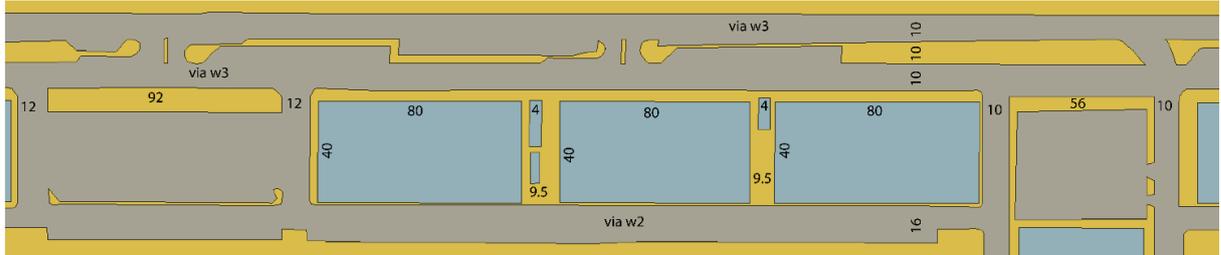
Corte 04 - Casas paralelas às vias encontradas da 703 a 707 e comércio
